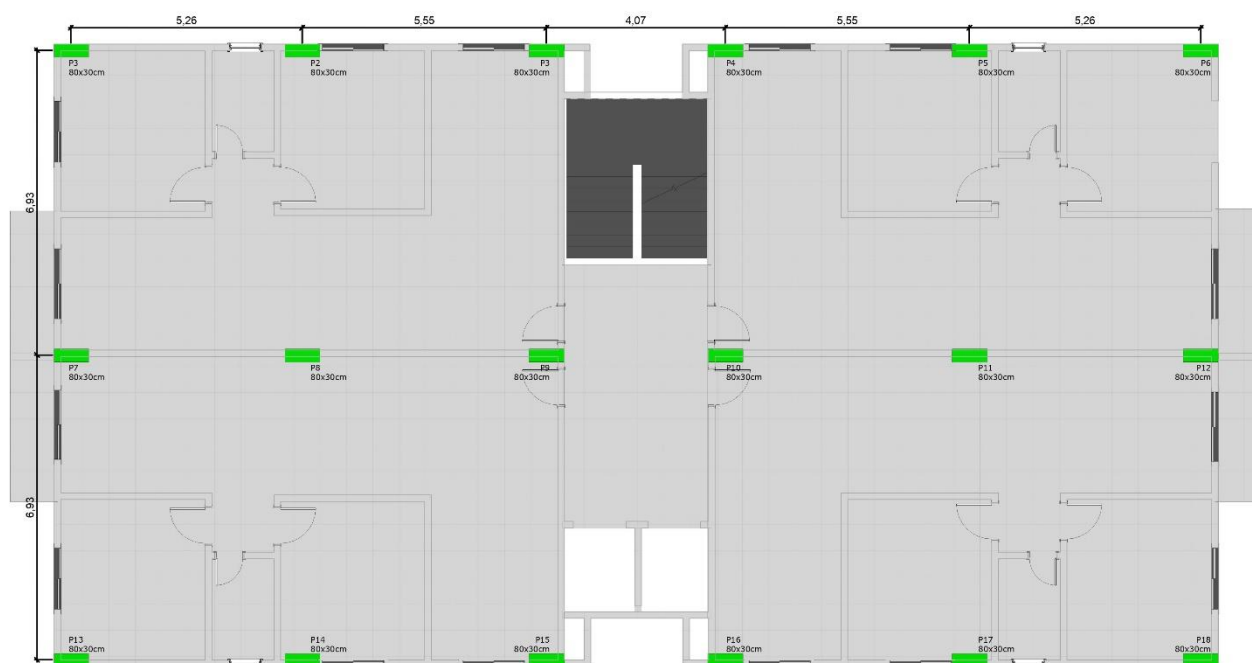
Planta de forma do pavimento tipo – 1º Caso. Fonte: Autor (2022).
